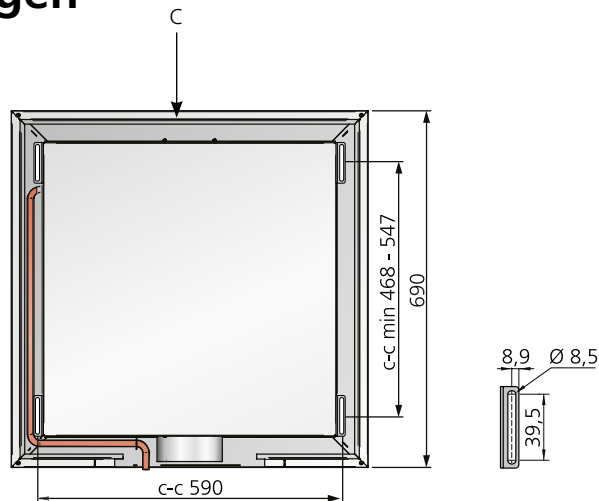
Parasol EX 690, Ansicht von oben mit Anschlussbefestigung
